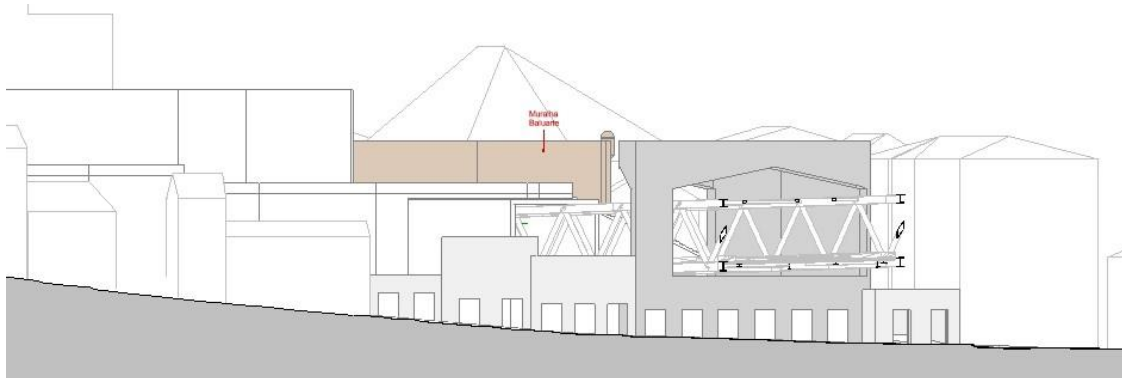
Alçado Baluarte e encontro (ML 134364).
